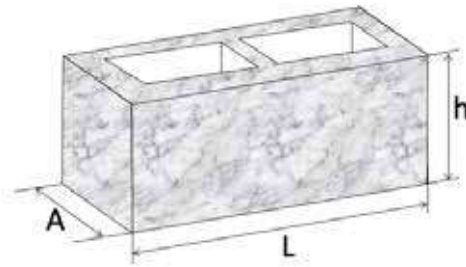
Forma prismática de la pieza. Fuente: Elaboración propia
